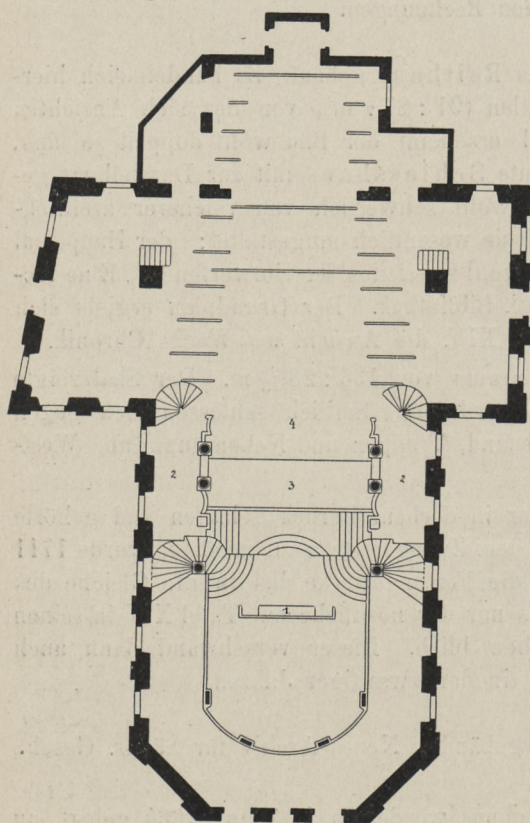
Comödienhaus von 1667, Grundriss.
